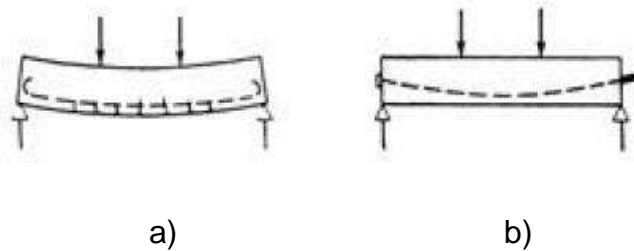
Deformación y agrietamiento para dos vigas.
